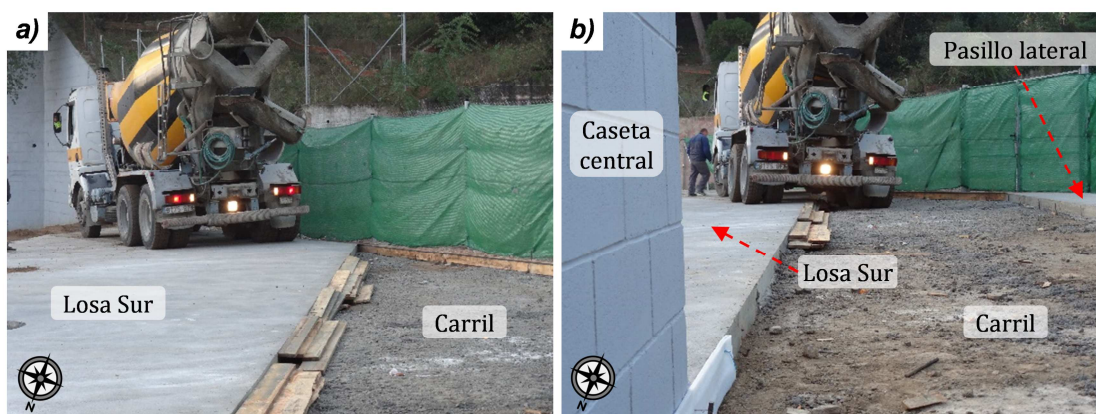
81 – a) paso del camión por la losa Sur; b) acceso al carril a hormigonar
